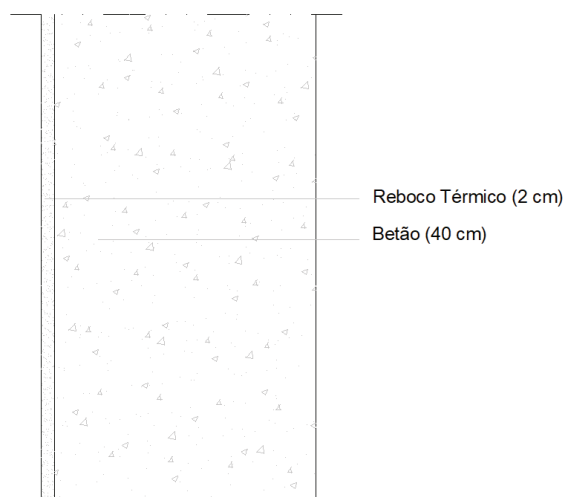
Pormenor construtivo da parede interior tipo XVI (escadas/áreas técnicas)
